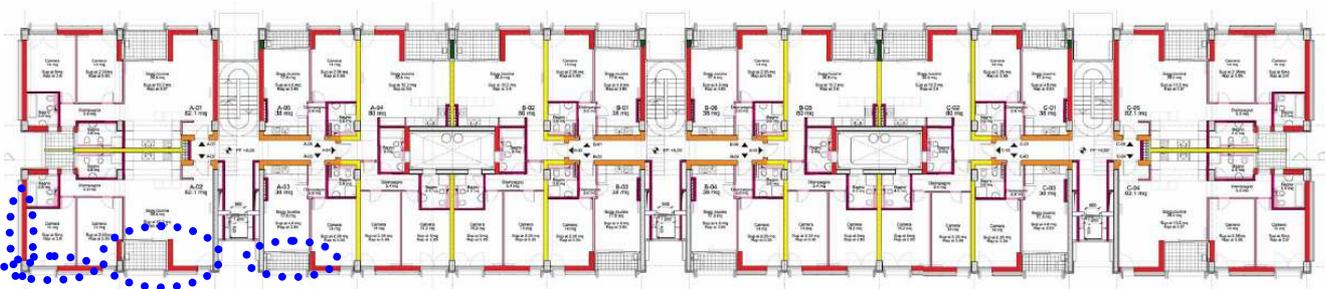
Indicazione delle facciate oggetto di valutazione, piano tipo
